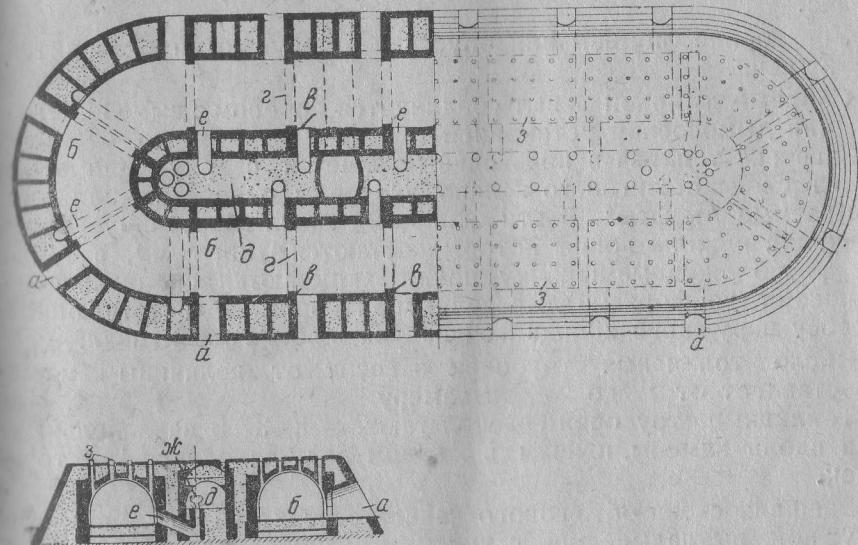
а—ходки; б—обжиговый канал; в—пилястры; г—шиберы; д—сборный дымовой канал; е—фуksы; ж—конус; з—люфты
